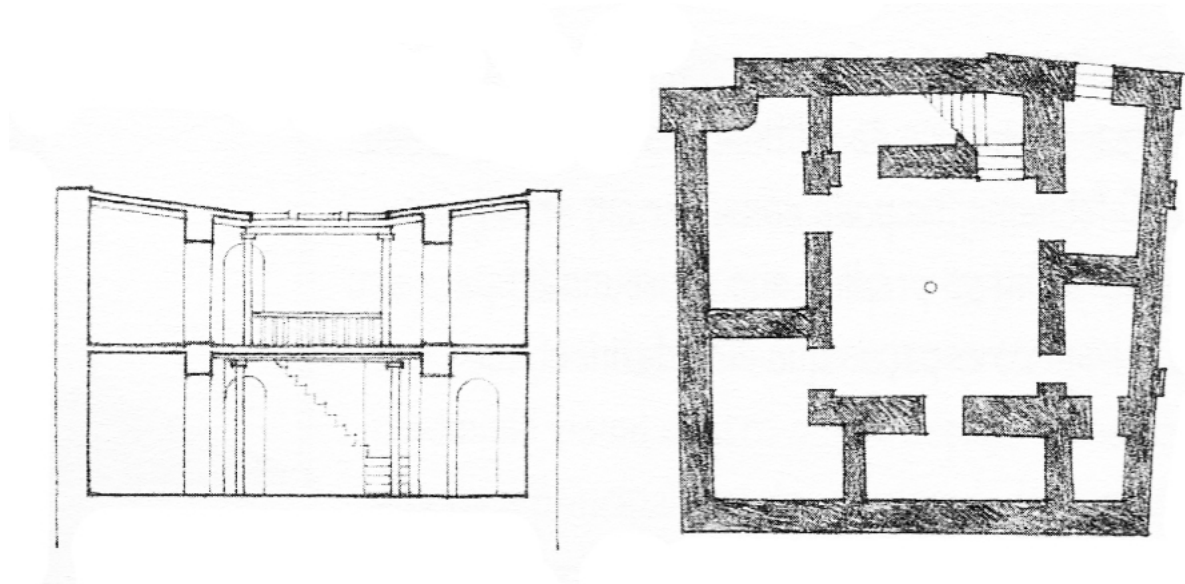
Casa com pátio em Ur, nº 3 da Rua Alegre. Entre séculos XIX e XVIII a.C. Corte e planta baixa. Fonte: CHING, 2013, p. 158.
